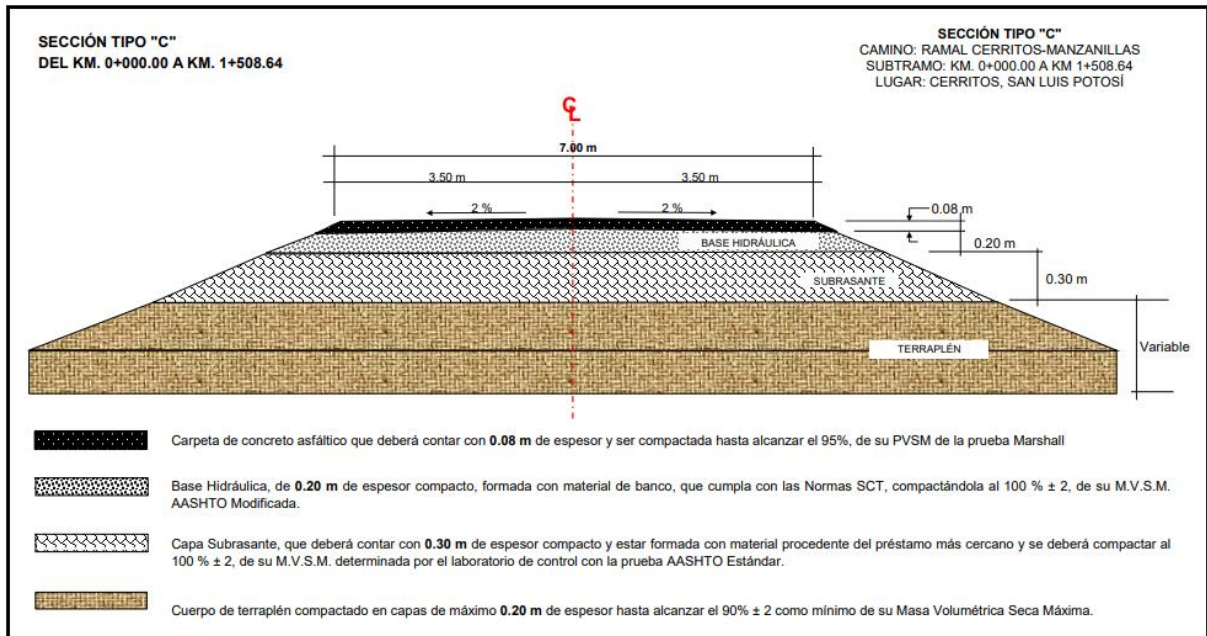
Sección de construcción para el proyecto del Ramal a Manzanillas.
